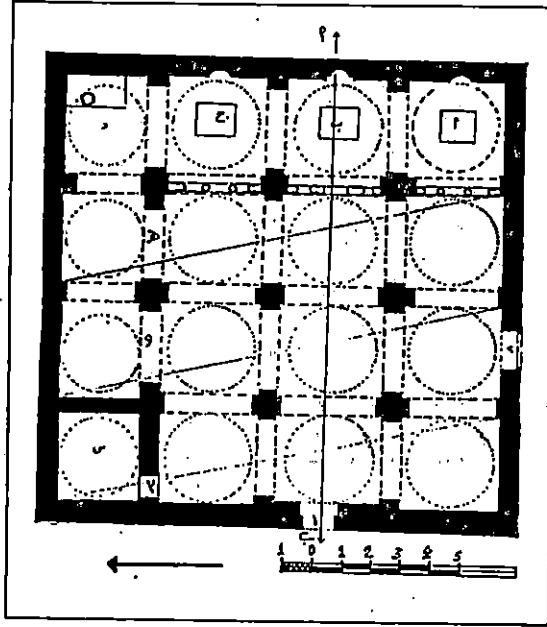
مسقط أفقي لكنيسة الست دميته
